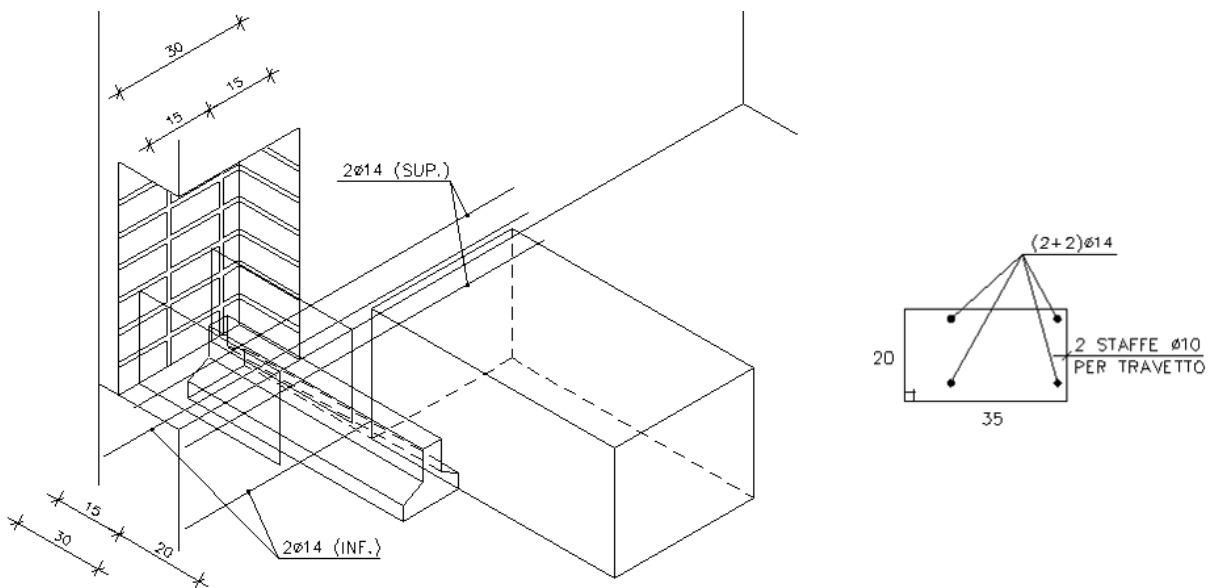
Ex-Lavanderie: particolare d'appoggio travetto di solaio in muratura esistente
